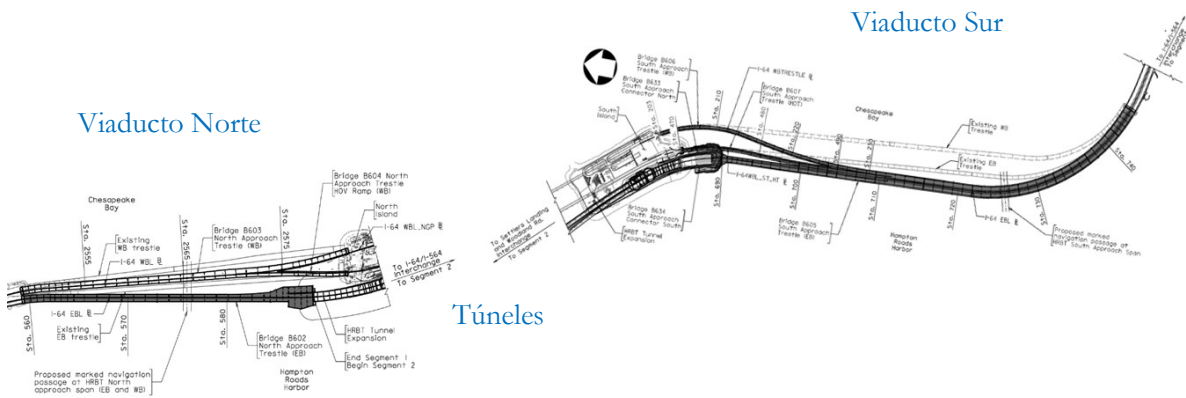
Planta de los viaductos Norte y Sur de acceso a los túneles en las islas.
